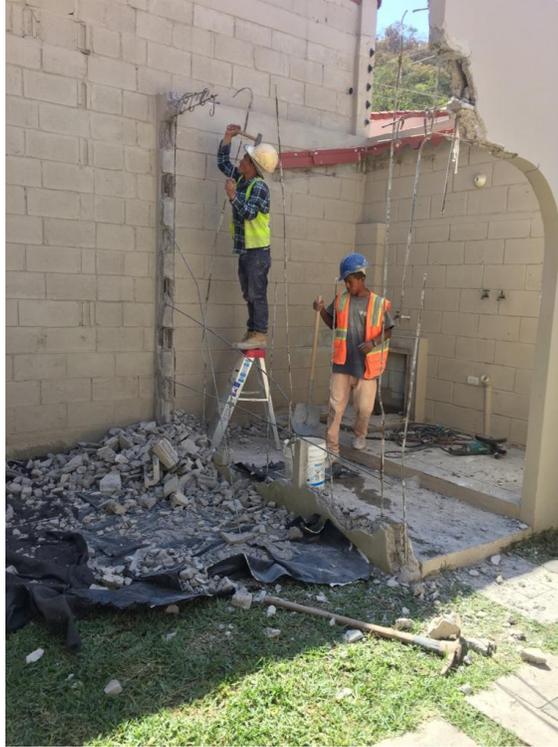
Demolición de pared de 3.05x 3.10 m.
